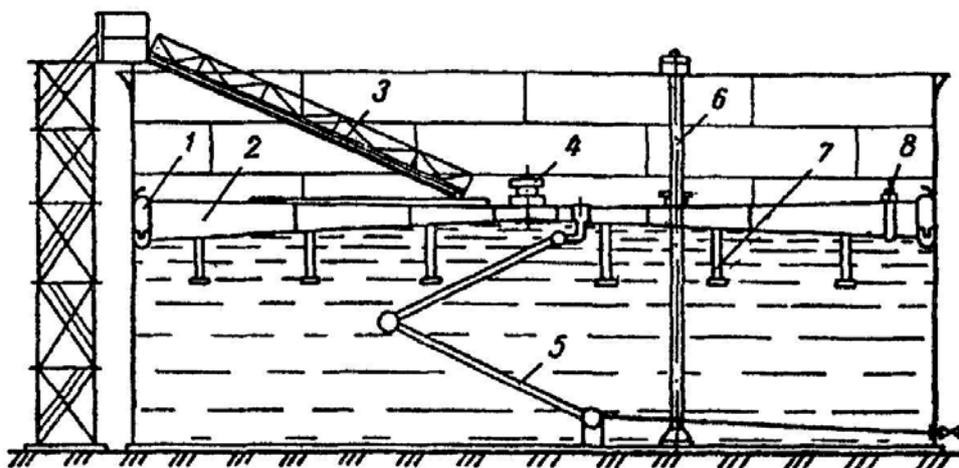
Резервуар с плавающей крышей: 1 - уплотняющий затвор; 2 - крыша; 3 - шарнирная лестница; 4 - предохранительный клапан; 5 - дренажная система; 6 - труба; 7 - стойки; 8 - люк
